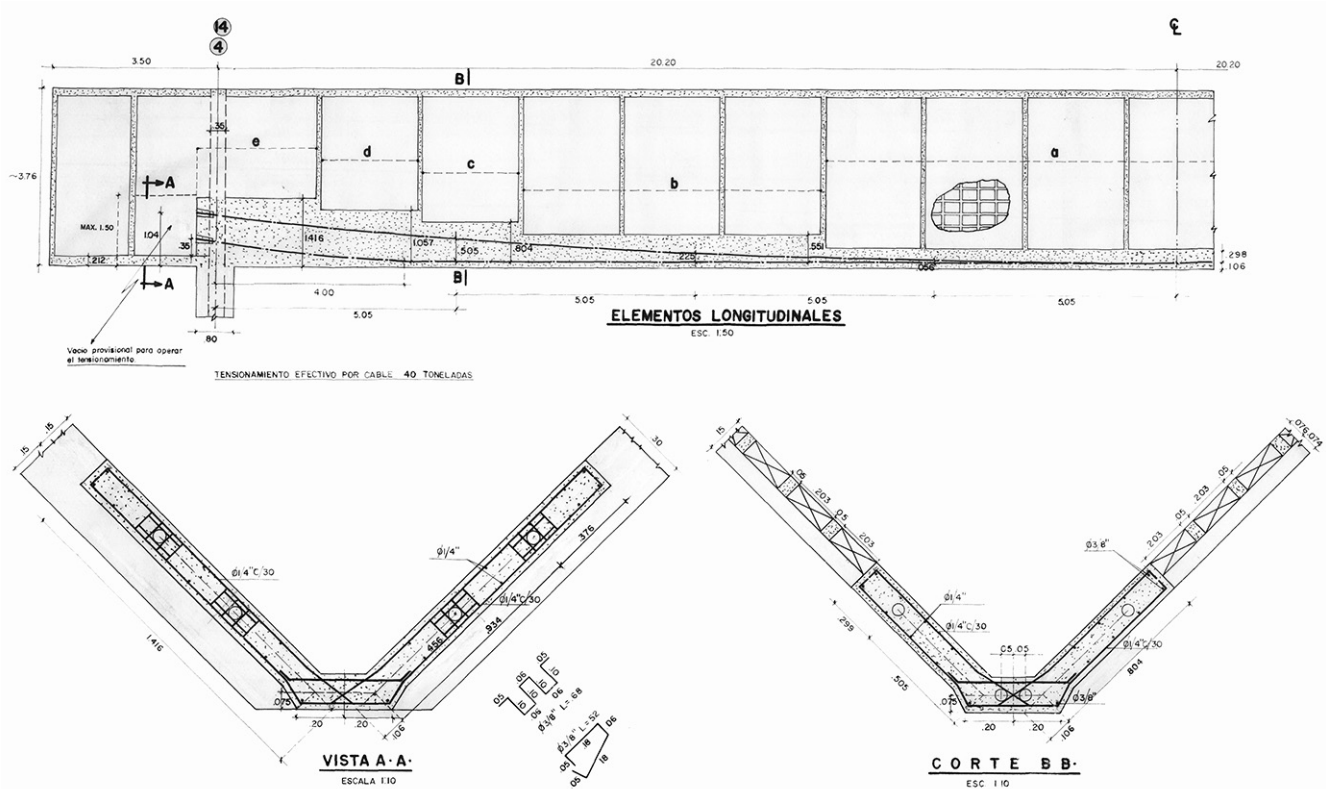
Detalle estructural de las plegaduras del coliseo de Barranquilla. Fuente: Archivo de Bogotá, Fondo Guillermo González Zuleta.
